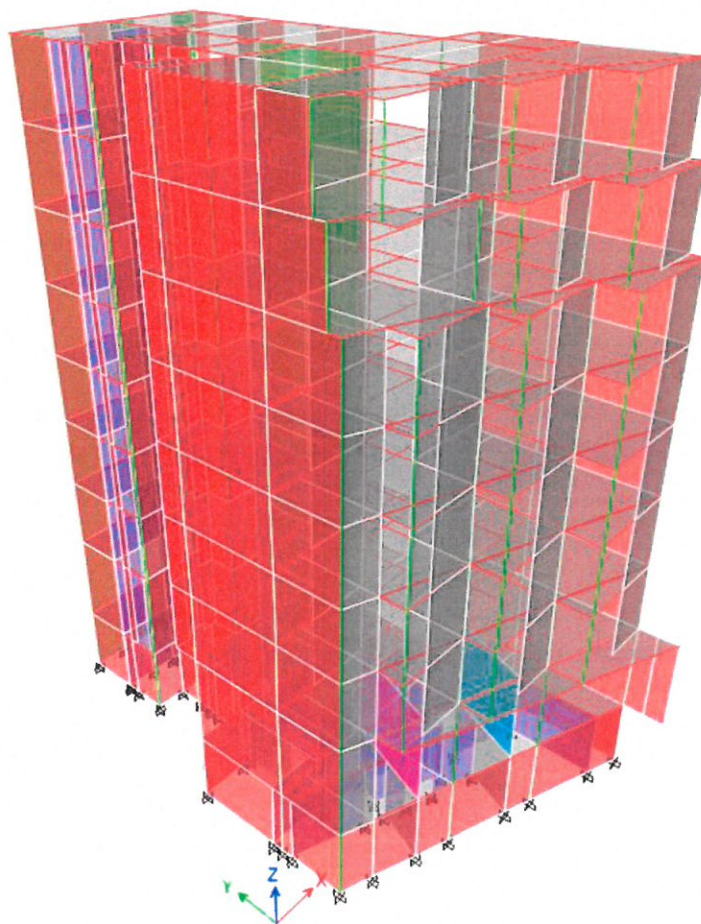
Vedere 3D (stânga)– model de calcul structural structura consolidată
